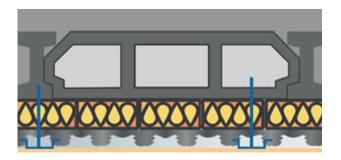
Aislamiento en falso techo suspendido de un forjado
